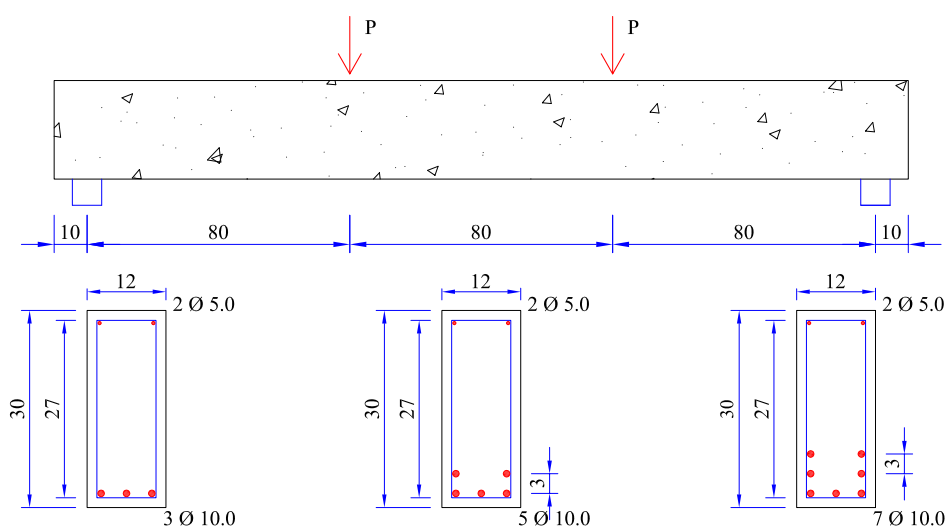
Detalhes da geometria, carregamento e armaduras das vigas de Álvares (1993).
